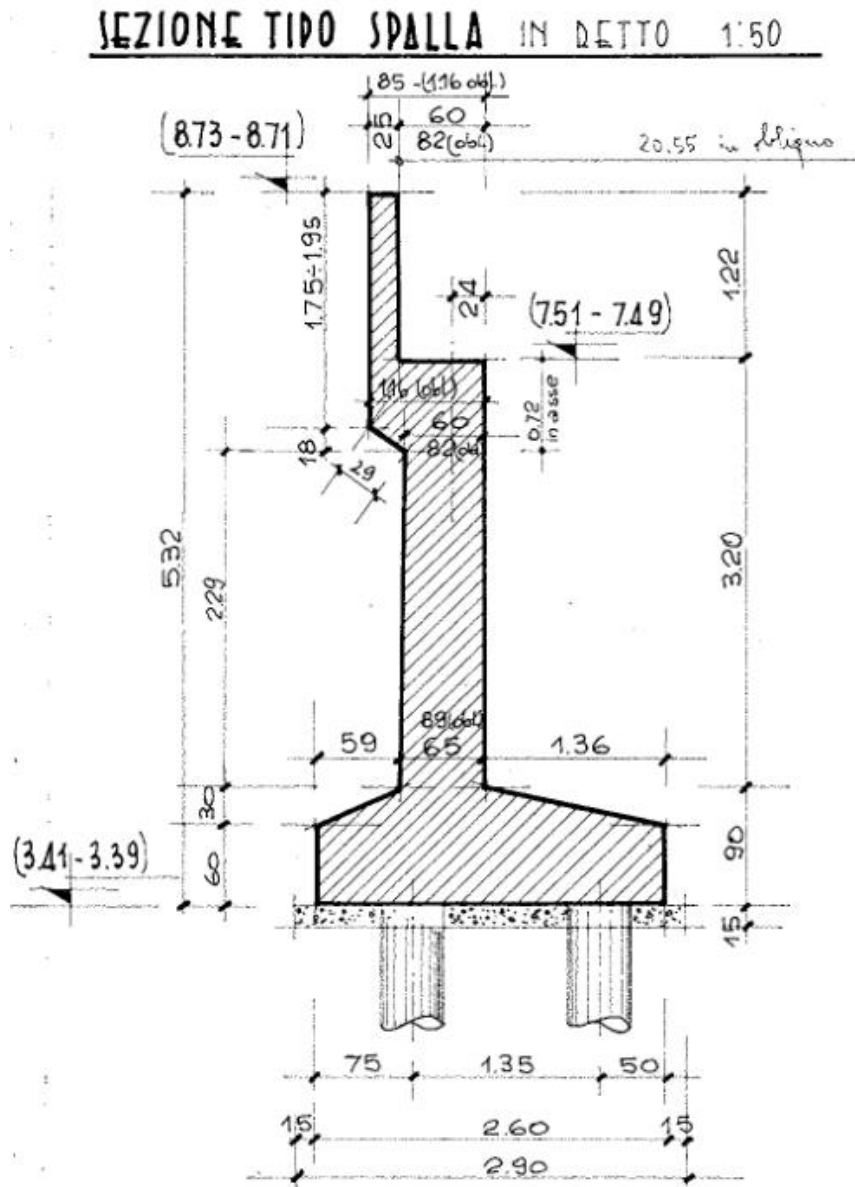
Sezione trasversale spalla esistente
